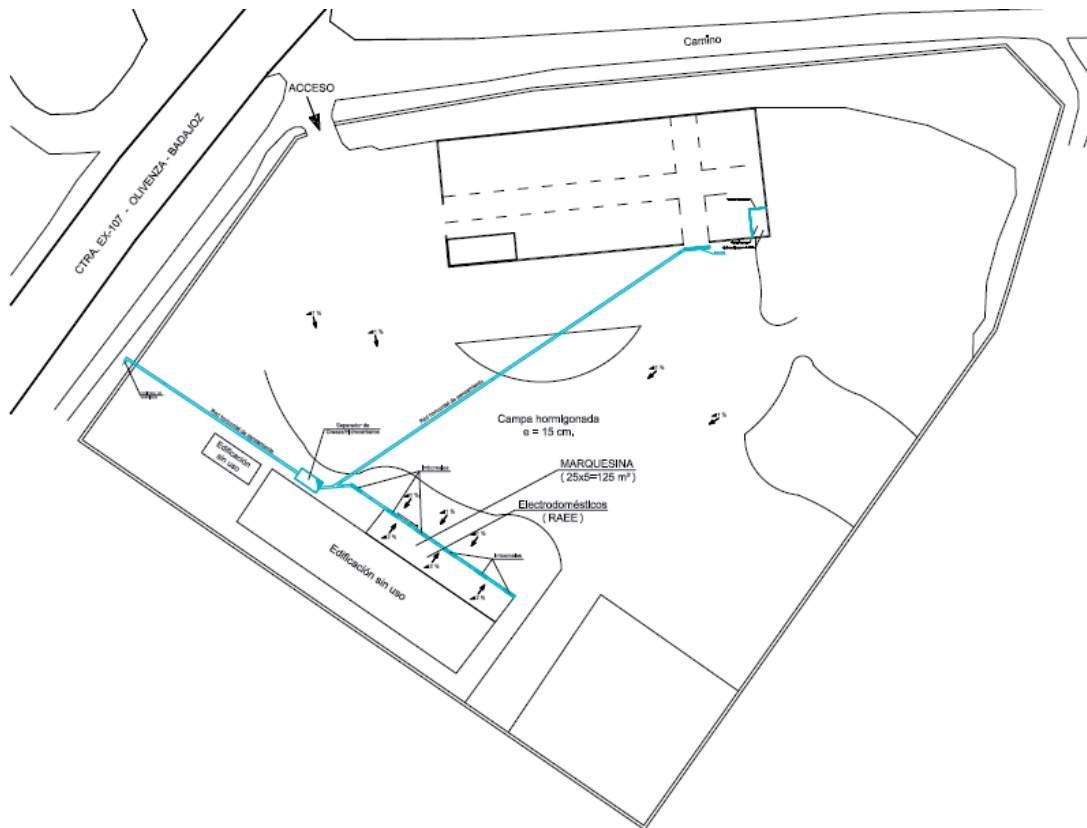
Plano en planta de las instalaciones. Redes de saneamiento
